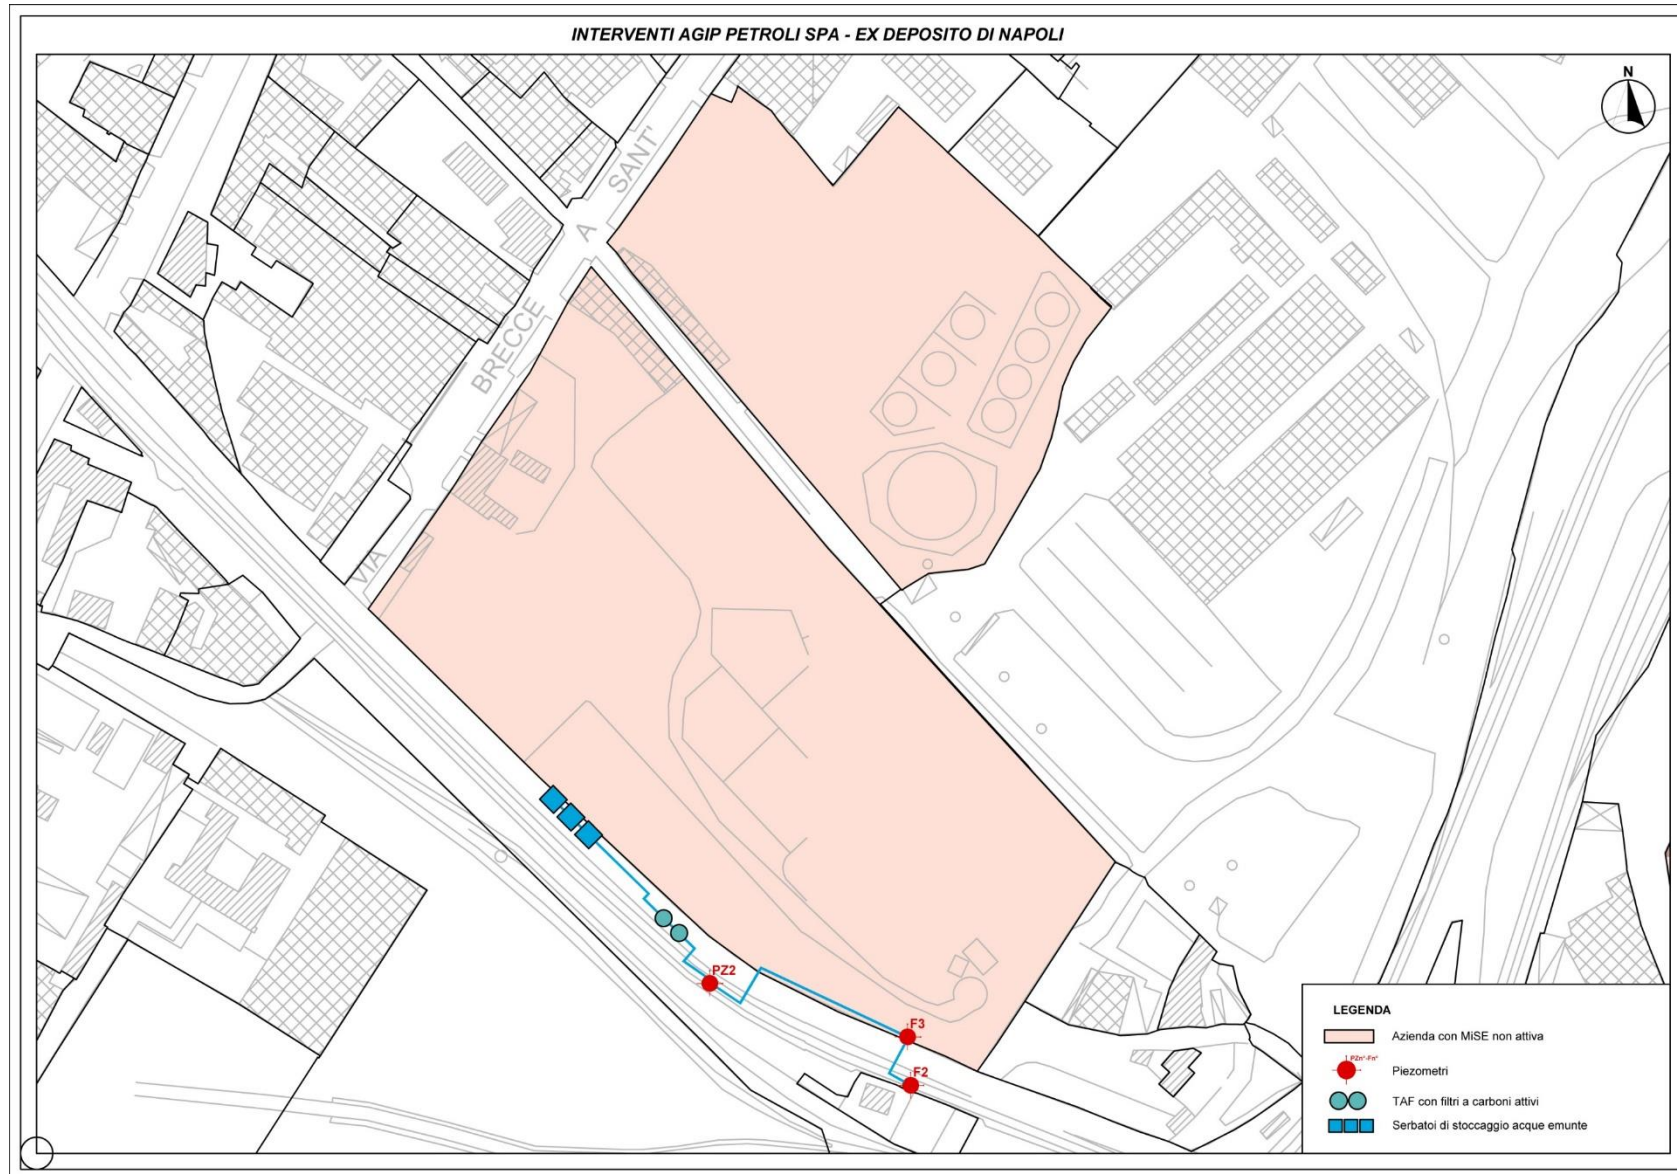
Planimetria intervento di Messa in Sicurezza “Agip SpA – Ex Deposito di Napoli”
